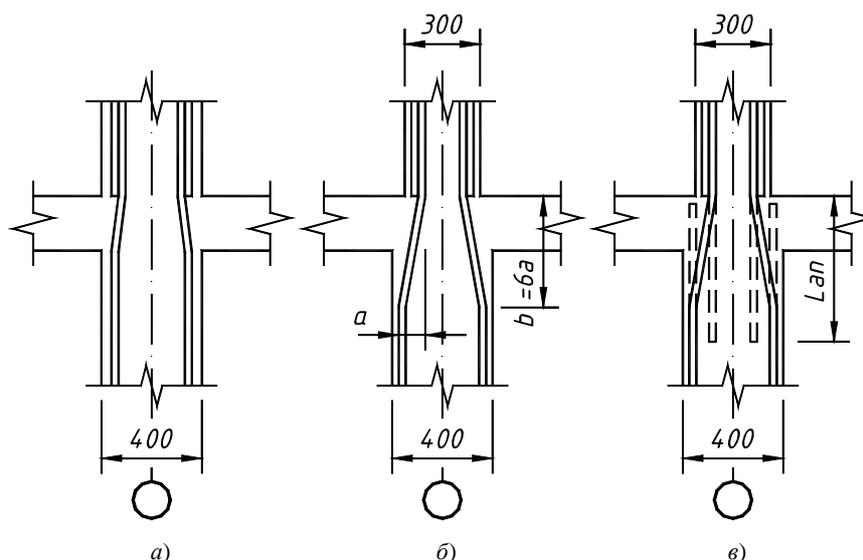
Схема устройства стыка продольных стержней колонны с помощью выпусков арматуры в уровне верха перекрытий:
